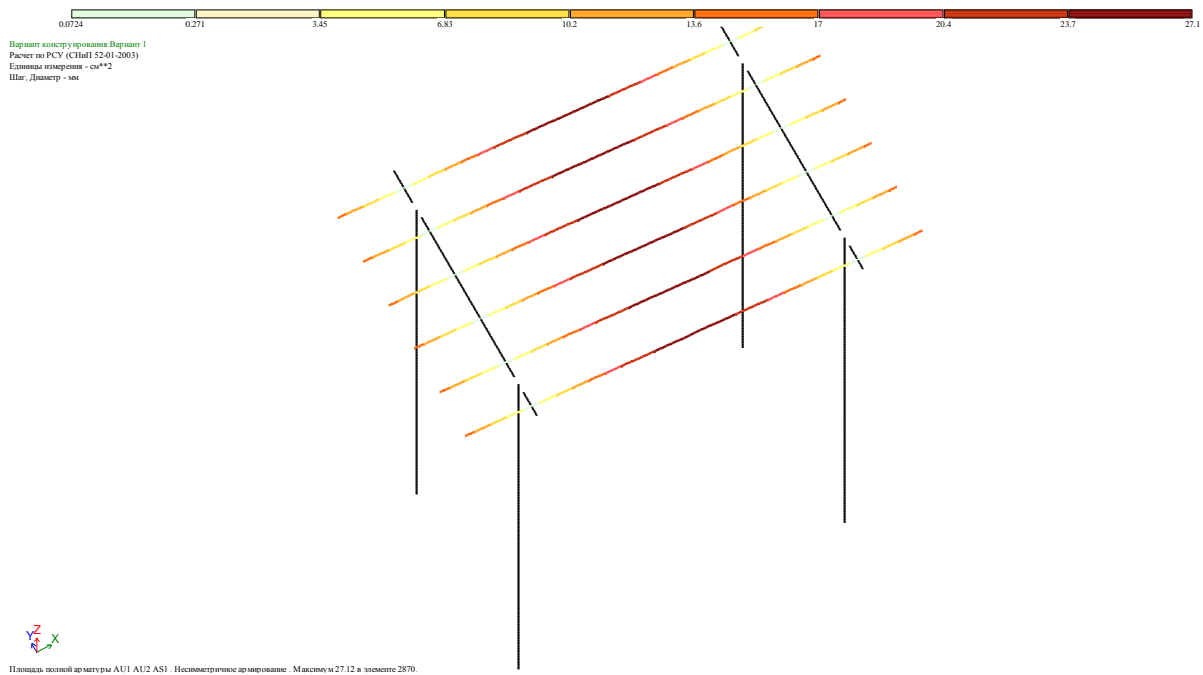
Требуемое нижнее армирование ребер рядовых плит перекрытия на «новые» нагрузки (без усиления)
